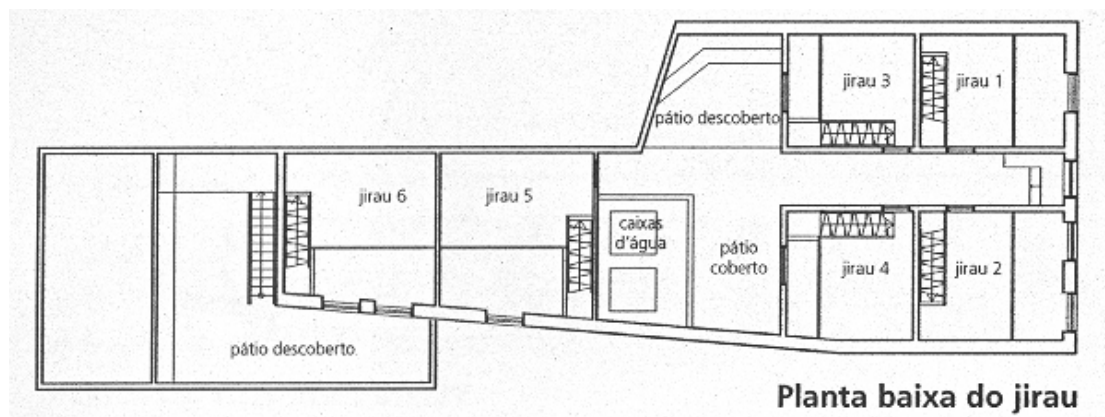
Cortiço na Travessa do Mosqueira, 20 – Planta baixa do jirau (SECRETARIA, 2000, p. 40).
